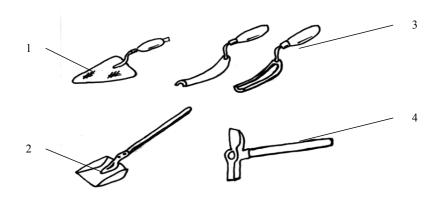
Инструменты для каменной кладки: 1 — кельма; 2 — растворная лопата; 3 — расшивки для выпуклых и вогнутых швов; 4 — молоток-кирочка
